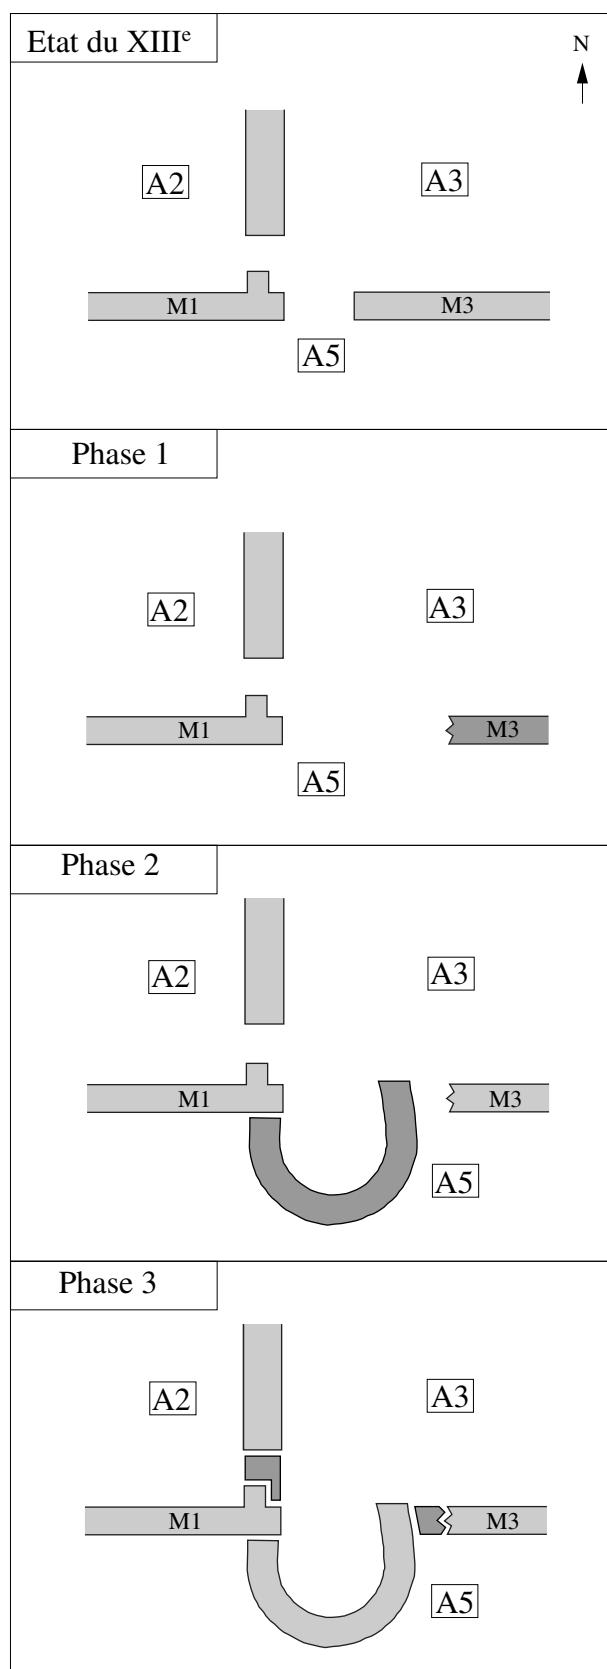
Plan au sol des étapes de construction de l'escalier (hypothèse).
